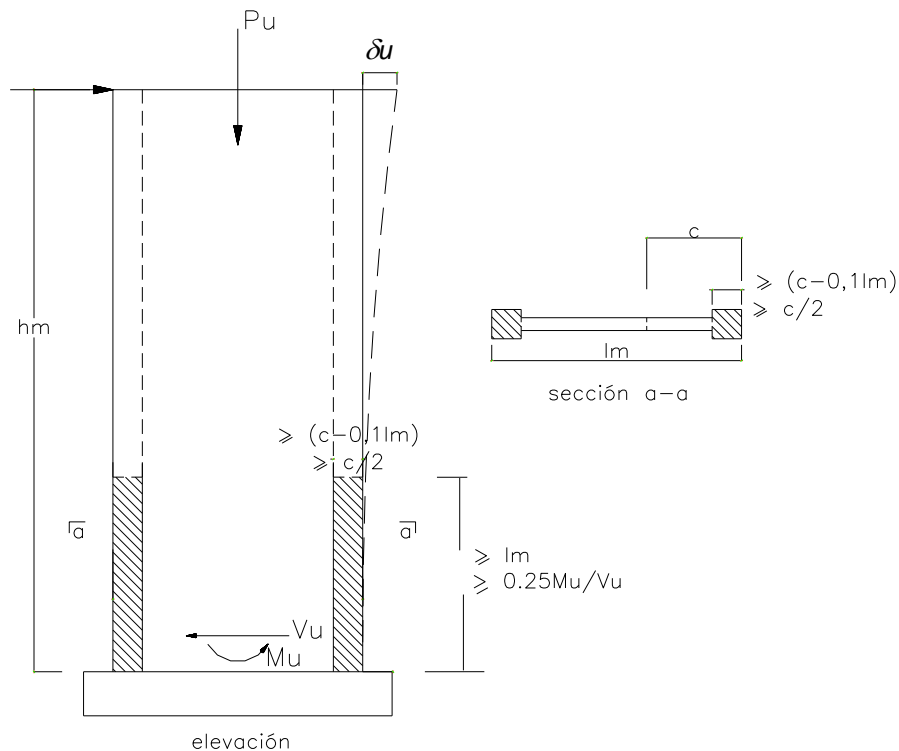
Elementos confinados de borde en muros.
